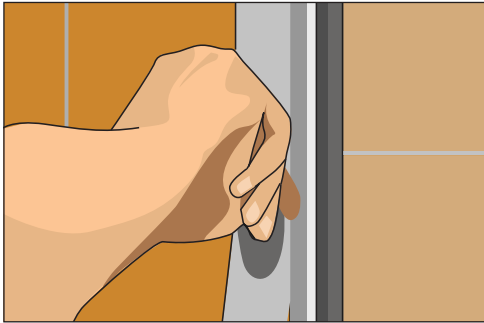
Устанавливаем на место стыка резиновую ленту
